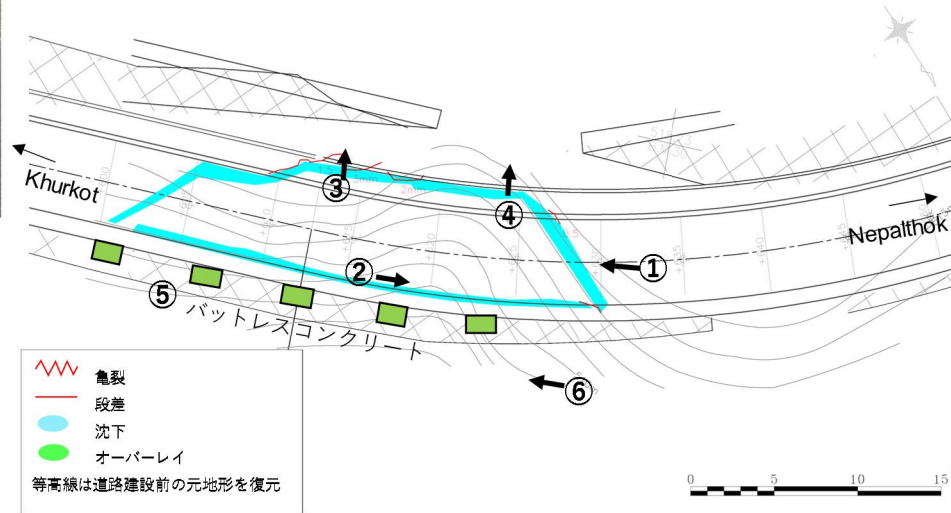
第二工区 Sta. 33+695 の周辺状況 (Non-Scale)
